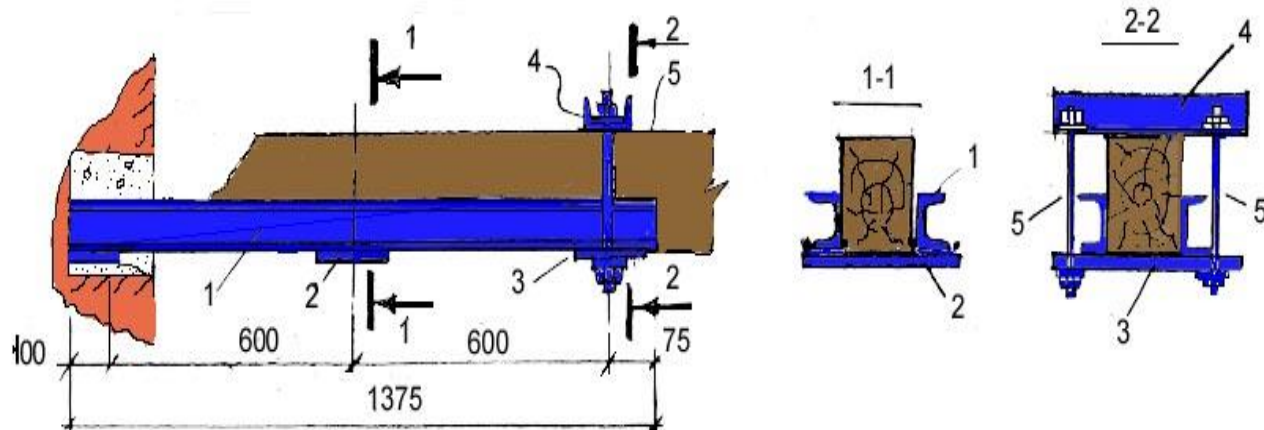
Усиление балки междуэтажного перекрытия стальным протезом: 1 – стальные боковые накладки - швеллер № 16-24; 2 – стальная упорная пластина – толщиной 20-24 мм (по расчету на изгиб) – нельзя применить стальной жесткий элемент с ребрами типа уголка или швеллера; 3 – пластина- шайба – толщиной 12 мм (конструктивно, нужна для опирания деревянной балки на монтаже); 4 – упорная шайба из швеллера № 12-16 (по расчету на изгиб); 5 – стальные тяжи $\Phi 16-20$ мм (с резьбой, расчет по $F_{нт}$).
